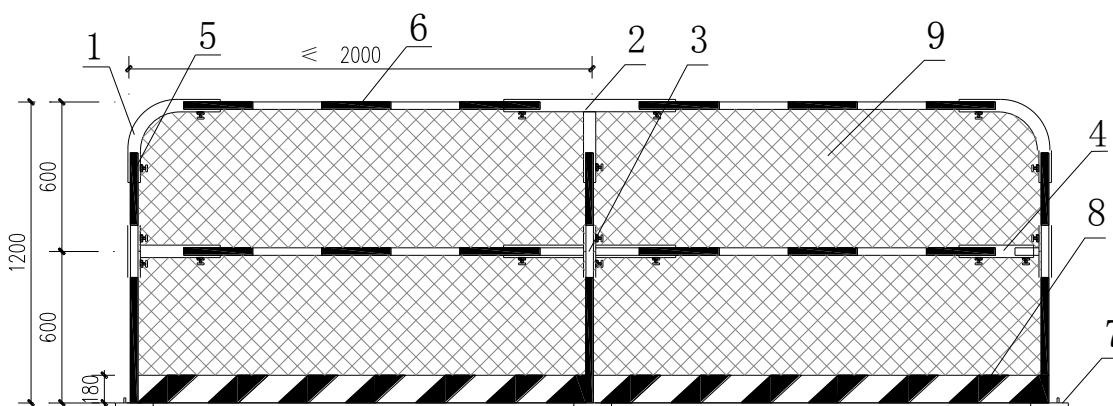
组装式防护栏示意图 (单位: mm)
